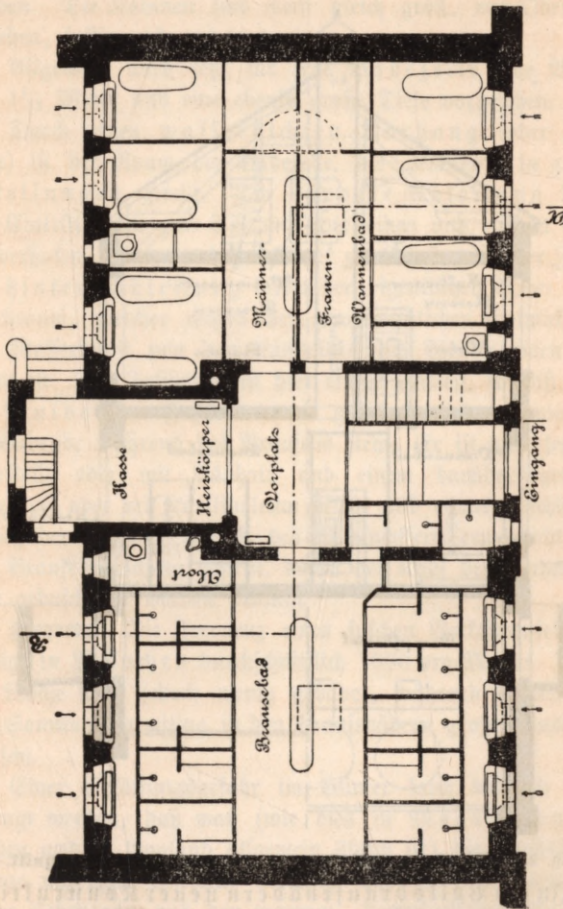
Münchner Volksbrausebad mit Wannenbädern, Erdgasofen-Grundriß.
